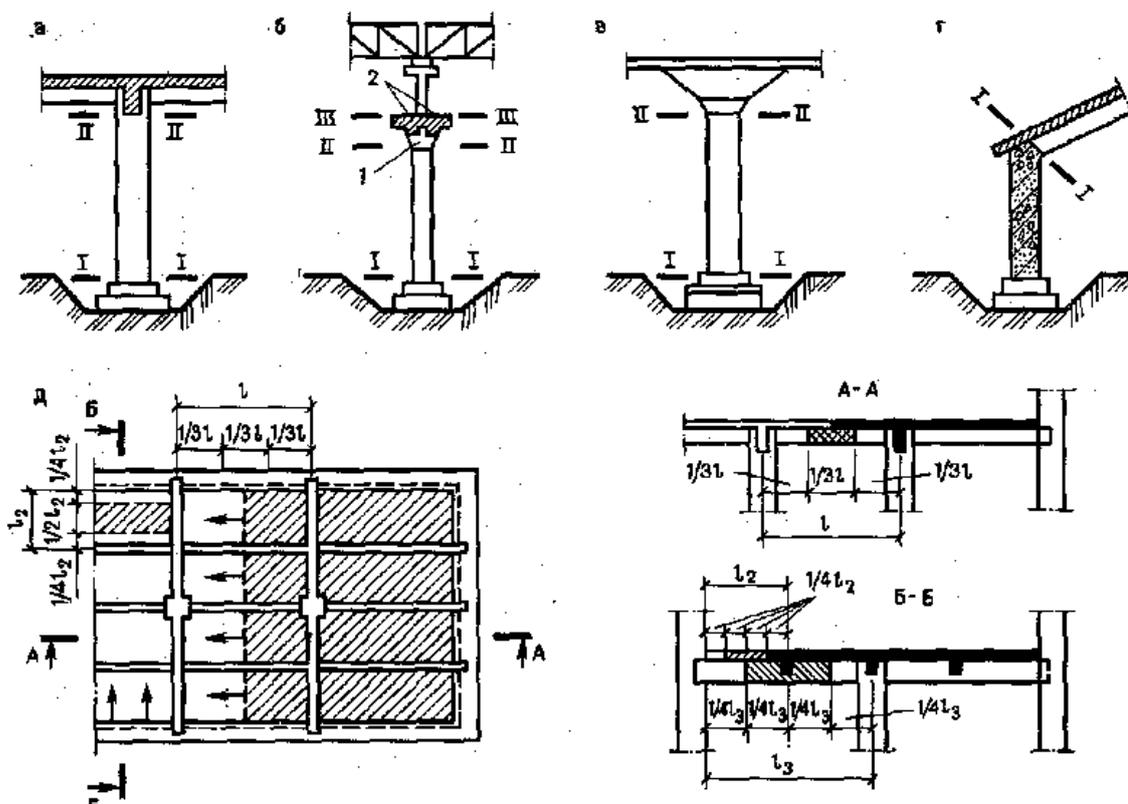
Расположение рабочих швов при бетонировании : а — колонн и балок ребристого перекрытия; б — колонн с подкрановыми балками; в — колонн с безбалочным перекрытием; г — стойки и ригеля; д — перекрытия в направлении, параллельном второстепенным балкам и в направлении, перпендикулярном второстепенным балкам; I, II, III — положение рабочих швов; 1 — колонна; 2 — подкрановая балка.
